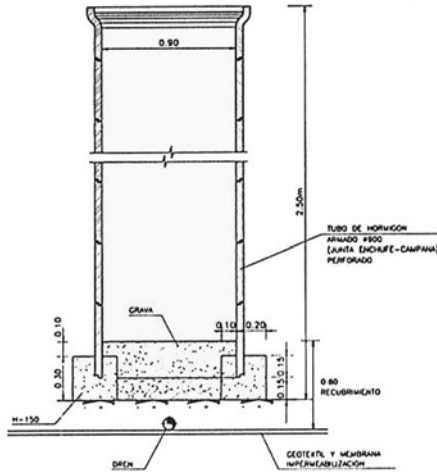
Chimenea con tubo de hormigón perforado para drenaje pasivo de biogás (Szantó, 2007).
